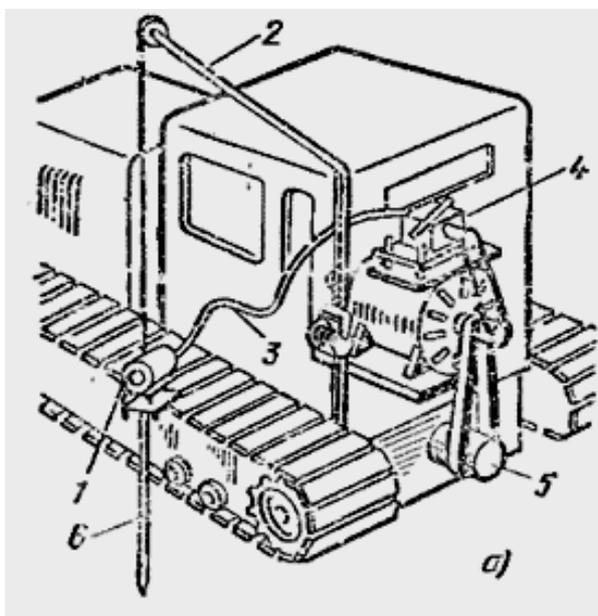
Забивка вертикальных электродов-заземлителей навесным механическим вибратором: 1 – вибратор; 2 – грузоподъемная стрела; 3 – гибкий приводной вал; 4 – сцепление; 5 – вал отбора мощности трактора и ременная передача на сварочный генератор и на сцепление привода вибратора; 6 – погружаемый заземлитель
